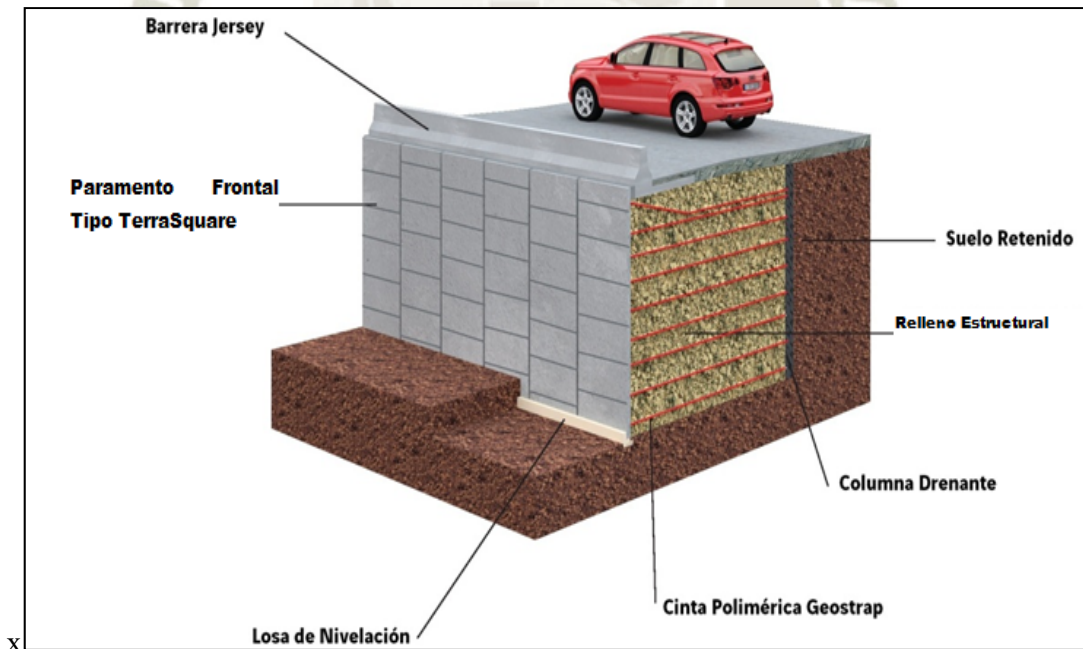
Esquema referencial muro de tierra armada tipo Terraplus
